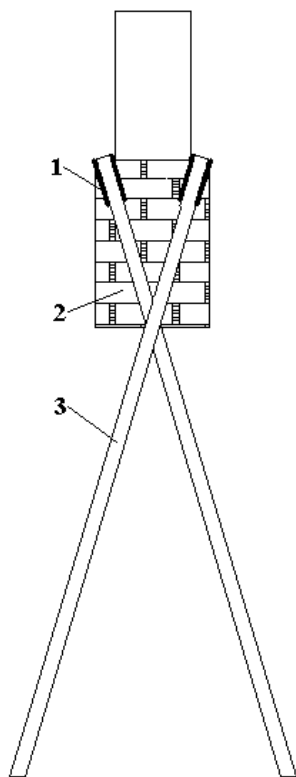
Этапы работ по усилению ленточных фундаментов набивными сваями
